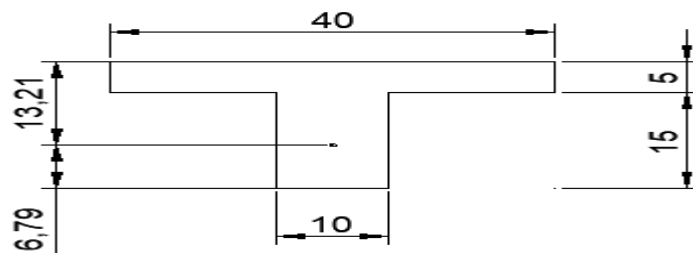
Sección T para el diseño de la losa aligerada Ig
